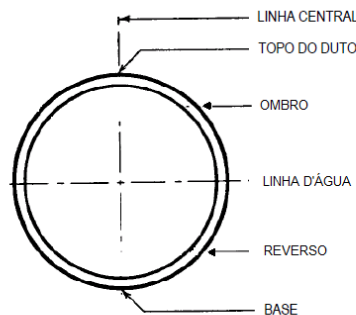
Identificação dos locais da seção transversal do duto (Modificado de Rubio, 2008).
